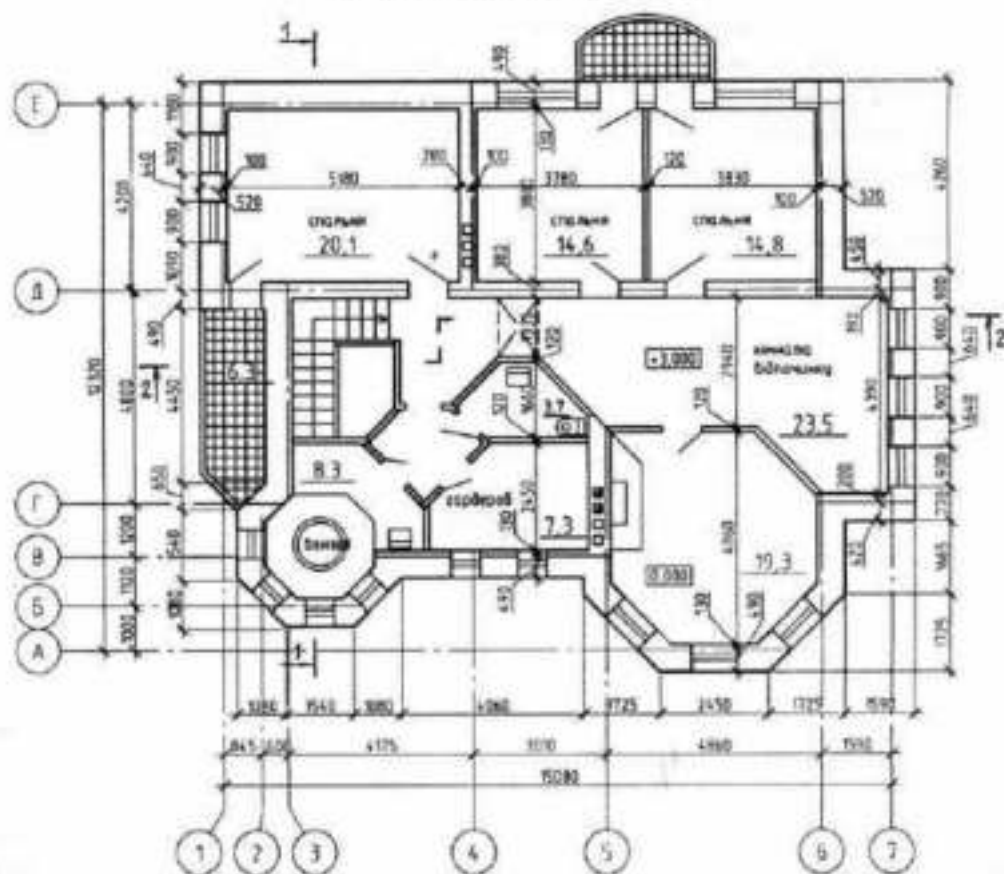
Приклад виконання робочого креслення плану другого поверху житлового будинку
